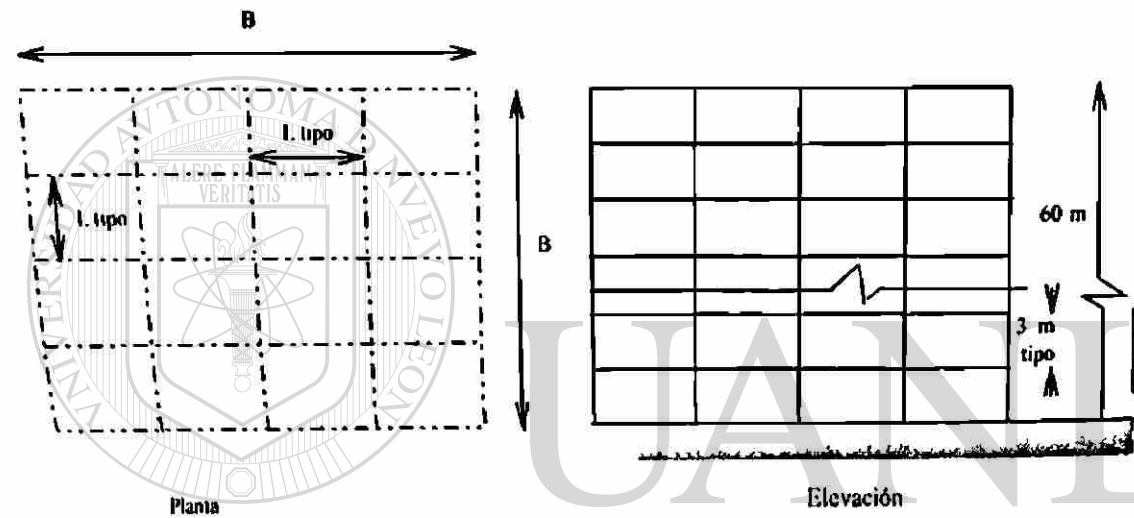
Planta y Elevación de los Edificios No. 1 y 5
